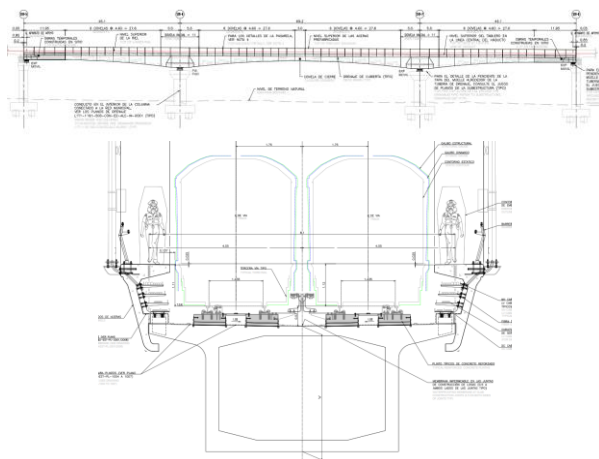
Alzado y sección del viaducto especial: Voladizos sucesivos 45+70+45 m.
